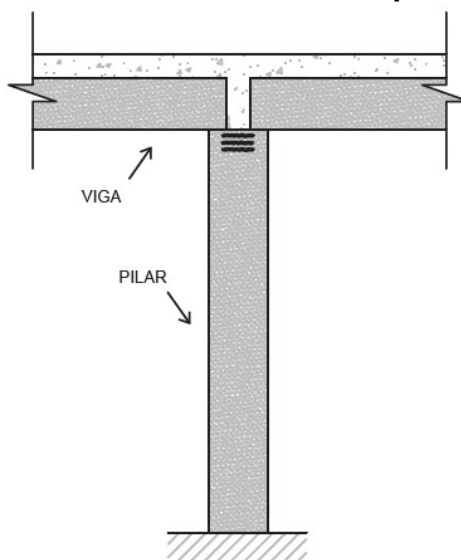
Fissuras inclinadas na cabeça do pilar provocadas por concentrações de tensões
